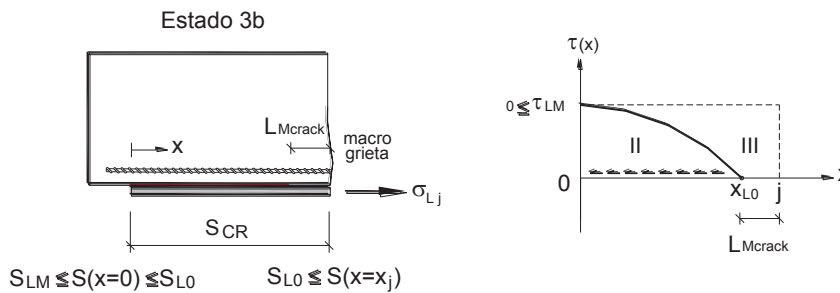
Distribución del esfuerzo cortante en un elemento de viga ubicado entre el extremo de la platina FRP y la grieta j más cercana, en el estado 3a
